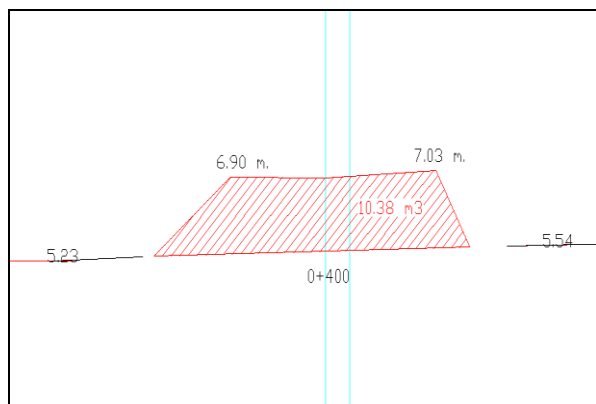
Sección de la estación 0+400 de la estructura ubicada en la margen derecha. (AUTOCAD 2010)
